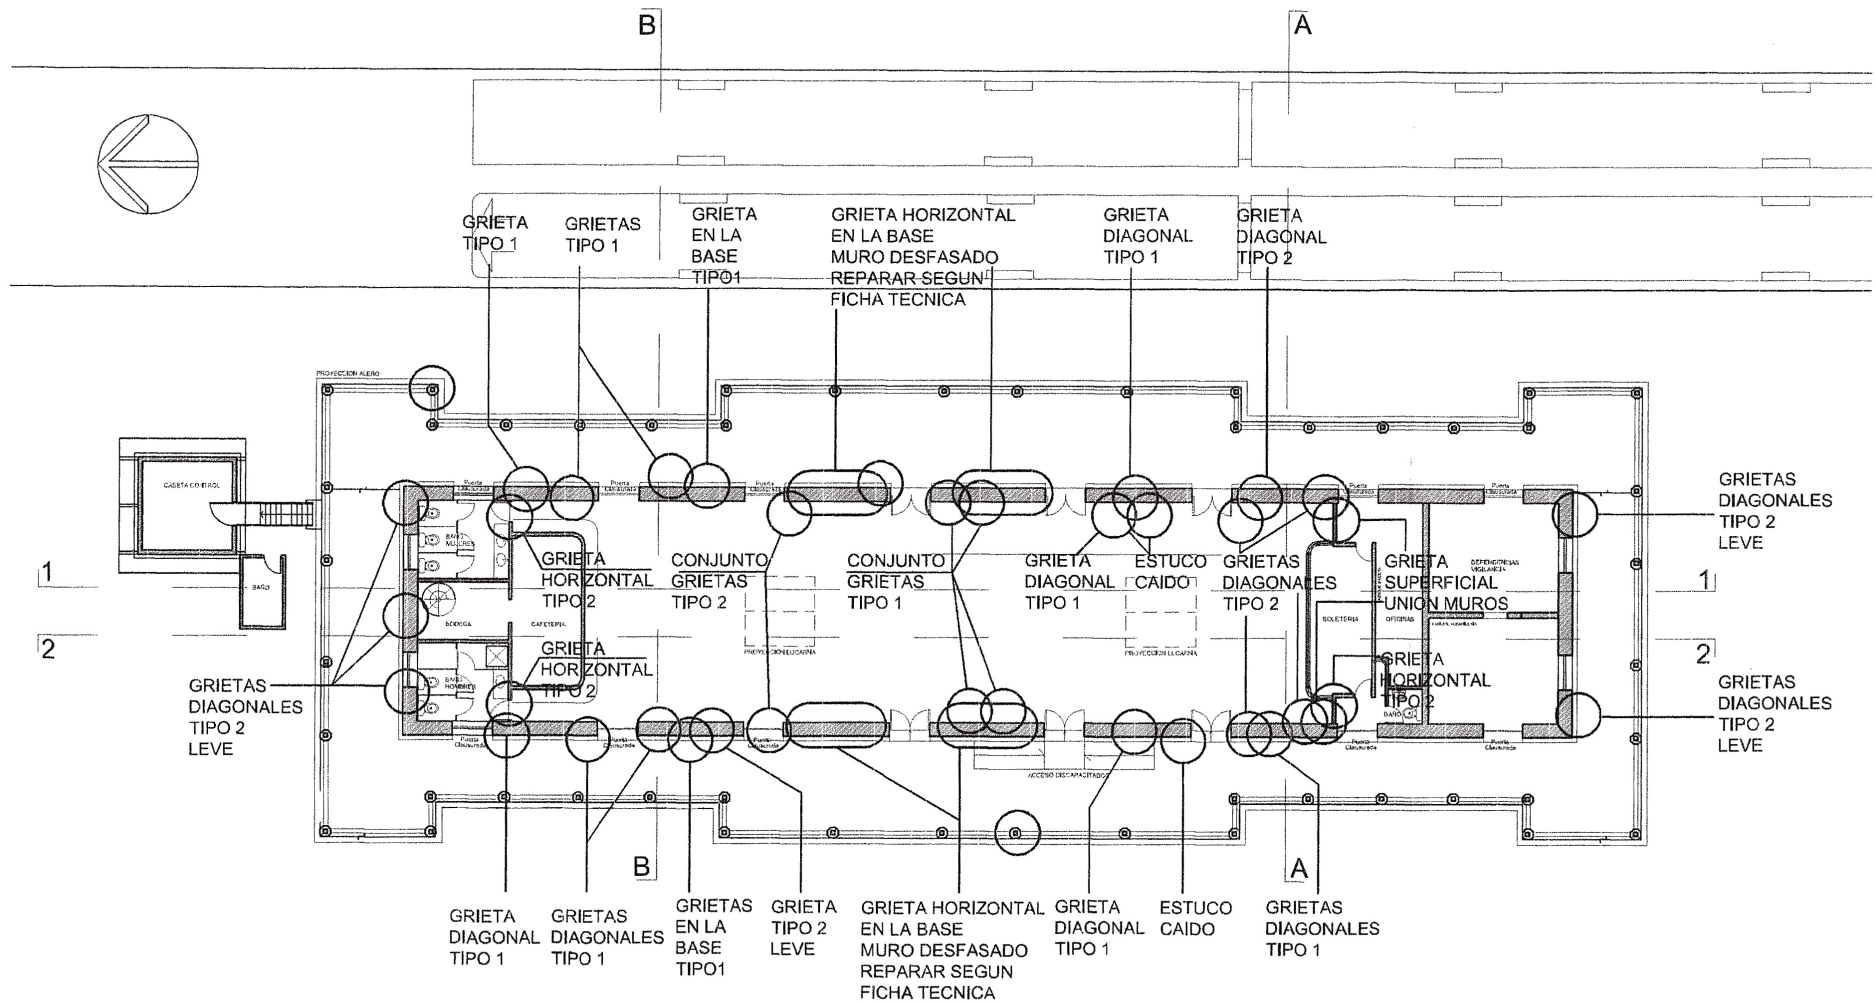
Planta de Daños Realizada por Ríffo & Strada 2010
